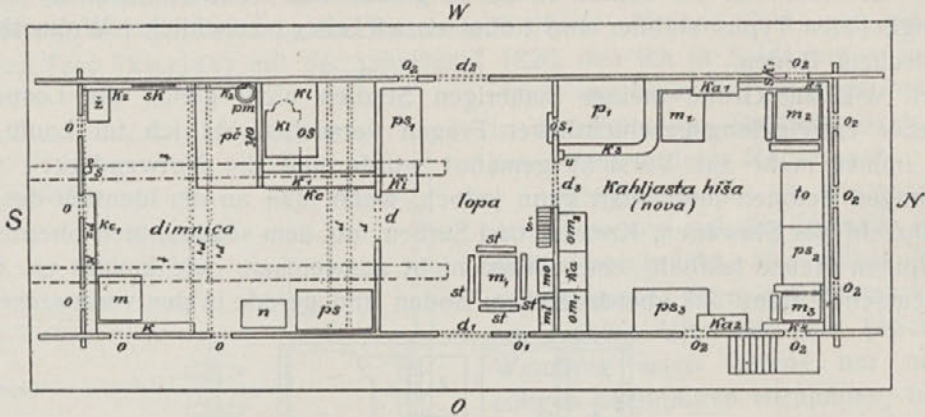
Grundriß des Hauses Nr. 5 in Šent Janž nad Dravčami (St. Johann ob Drautsch).
